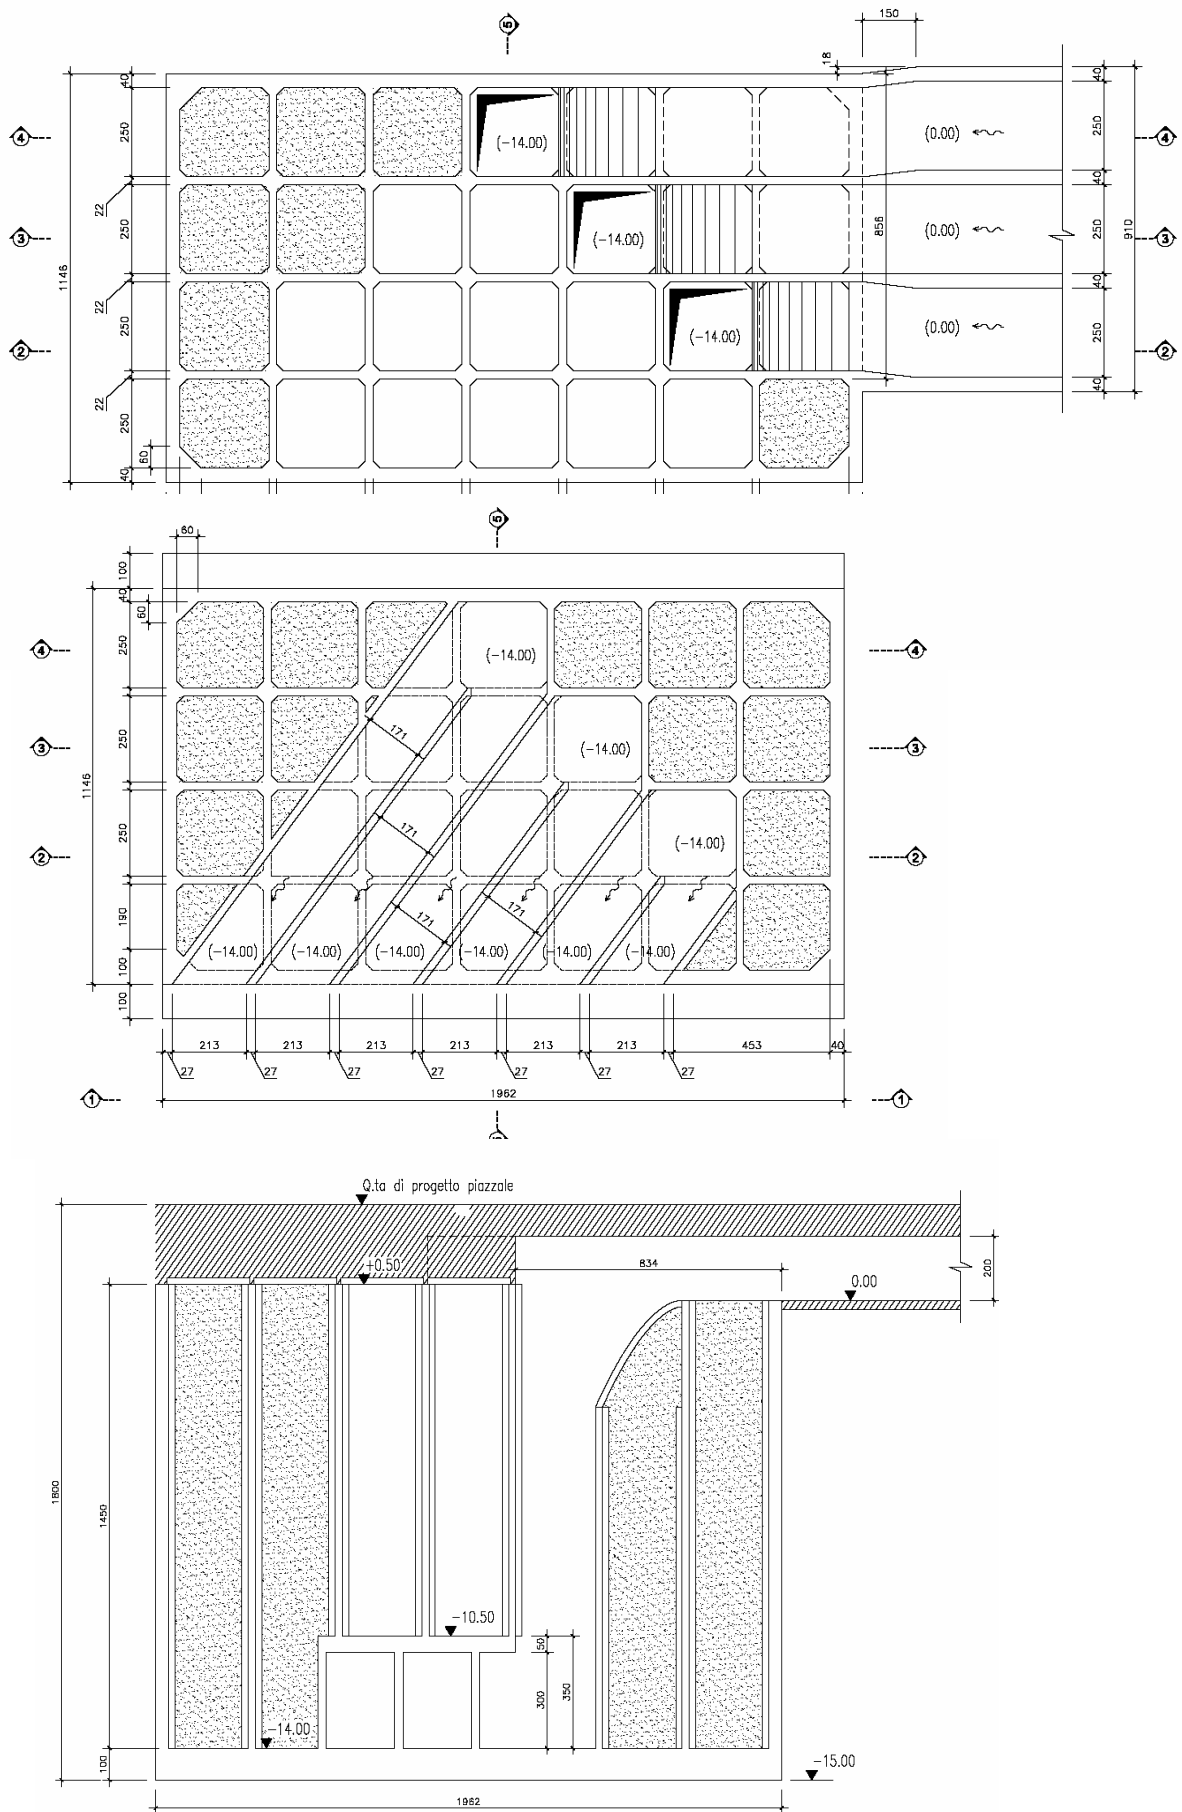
Opera di scarico - Piante e sezione
